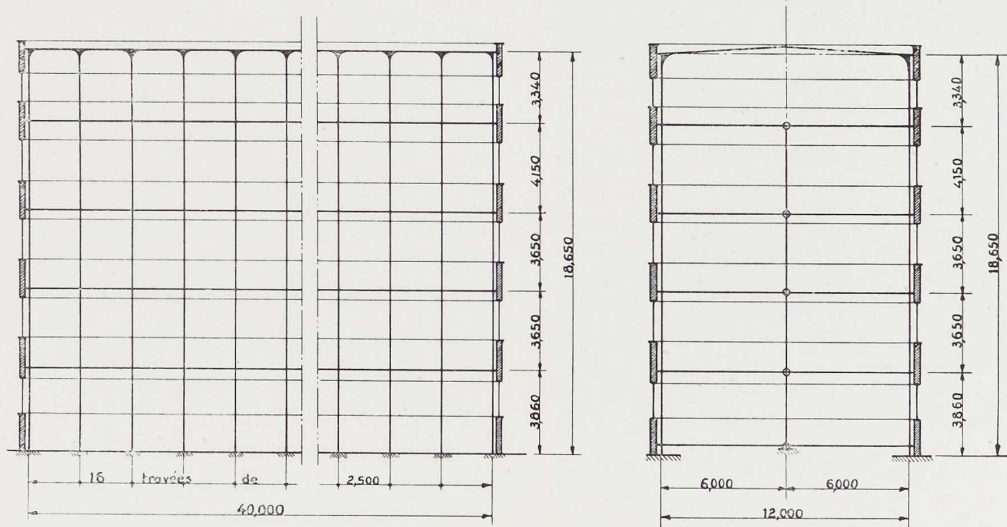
et 43. Coupes longitudinale (à gauche) et transversale (à droite) du nouveau bâtiment.
